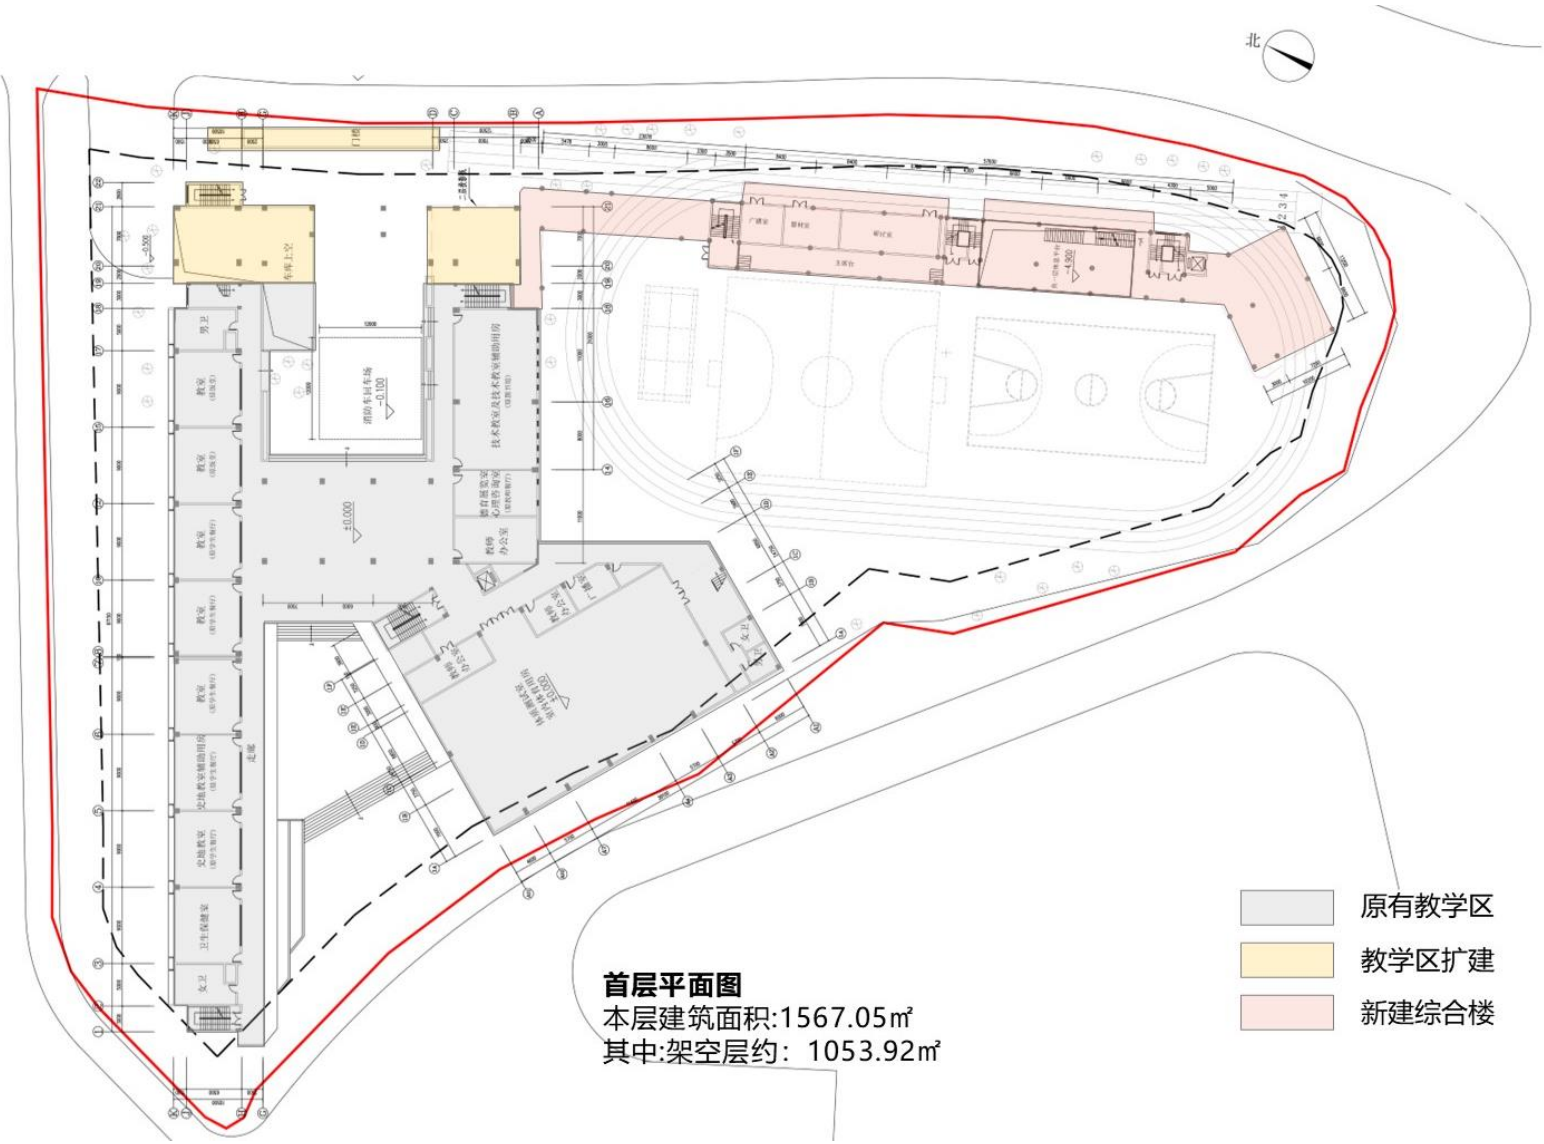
新建综合楼及电梯工程首层改造平面图
